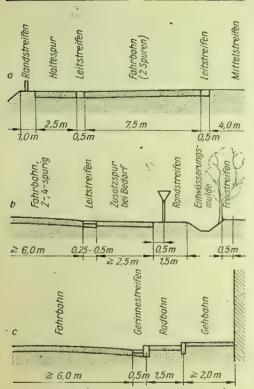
Querschnitte a einer Autobahn, b einer Landstraße und e einer Stadtstraße
